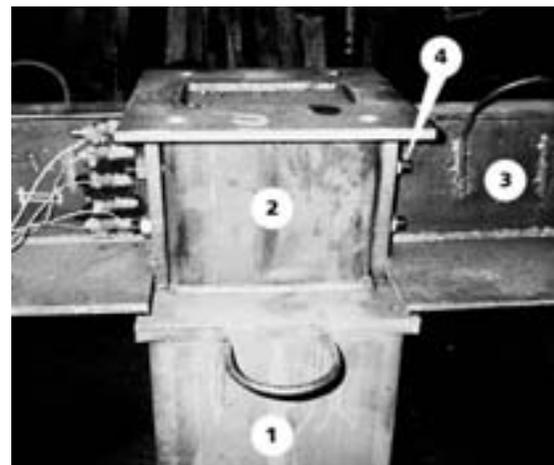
Соединение ригеля с колонной: 1 — колонна; 2 — стыковой элемент; 3 — ригель; 4 — монтажные болты
